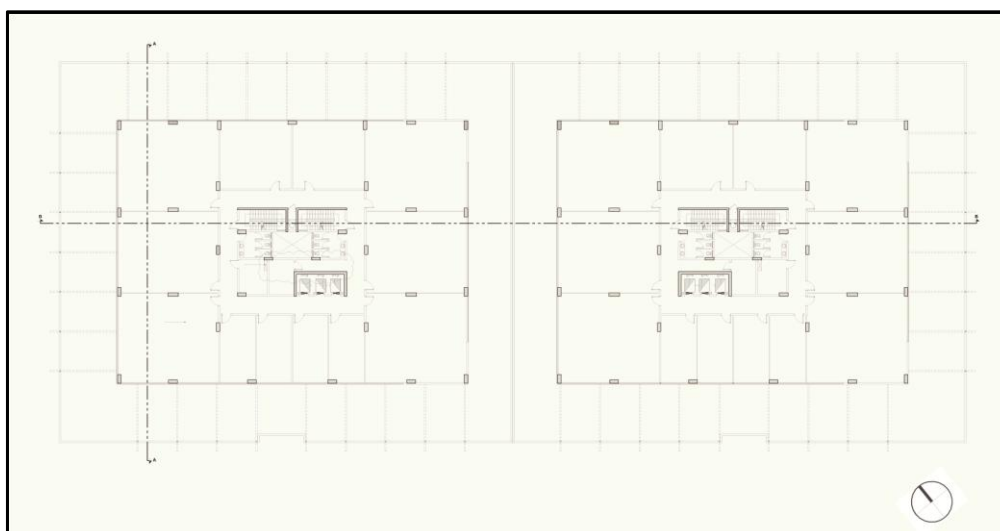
Pianta dell'edificio per uffici sito a Ras Al Khaimah
